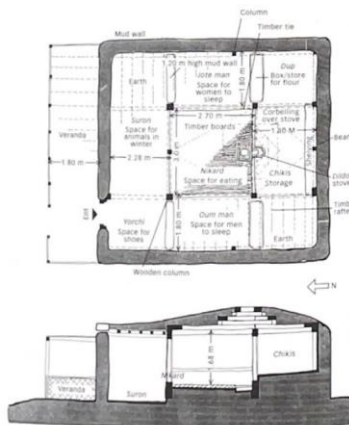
Grundriss und Schnitt eines Gilgit Hauses (links) (Quelle: Oliver, 1997, S. 1010)
